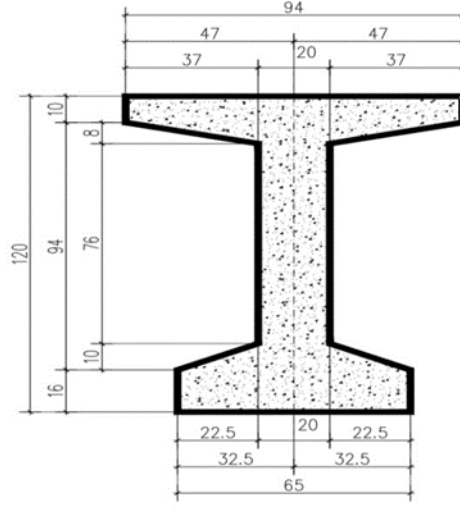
Orta ayak başlık kirişi yan kesit görünüşü
